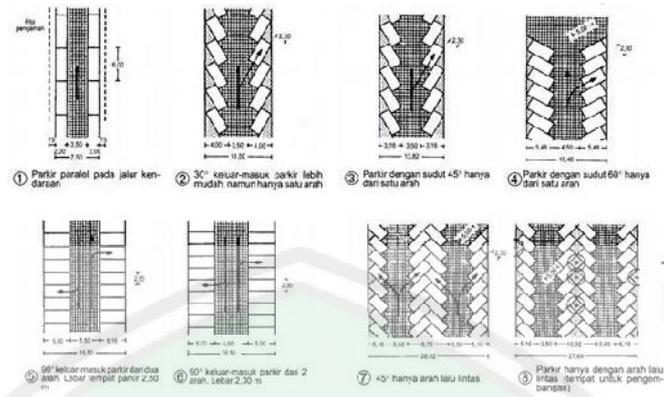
Standar Kebutuhan Ruang Parkir truk (sumber: Neufert, 2002: 101)
